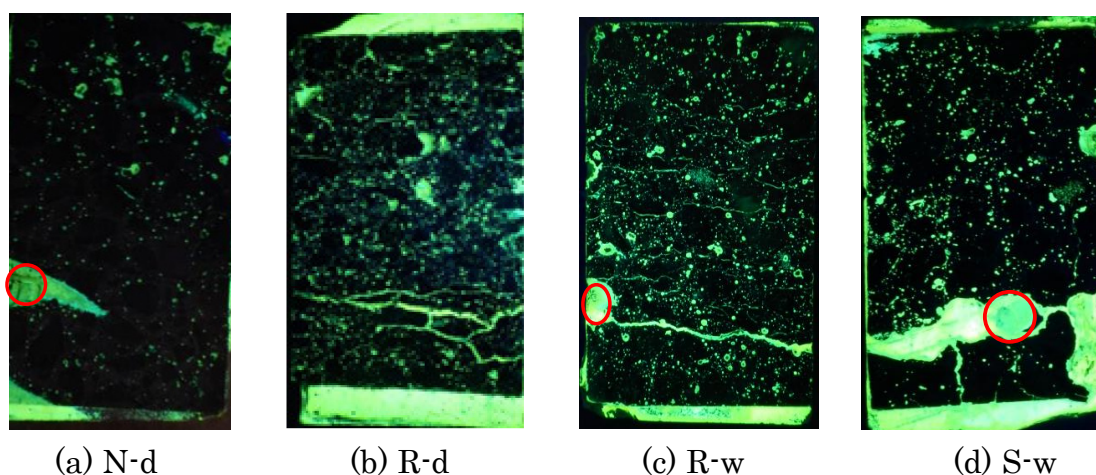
蛍光塗料によるひび割れの観察
